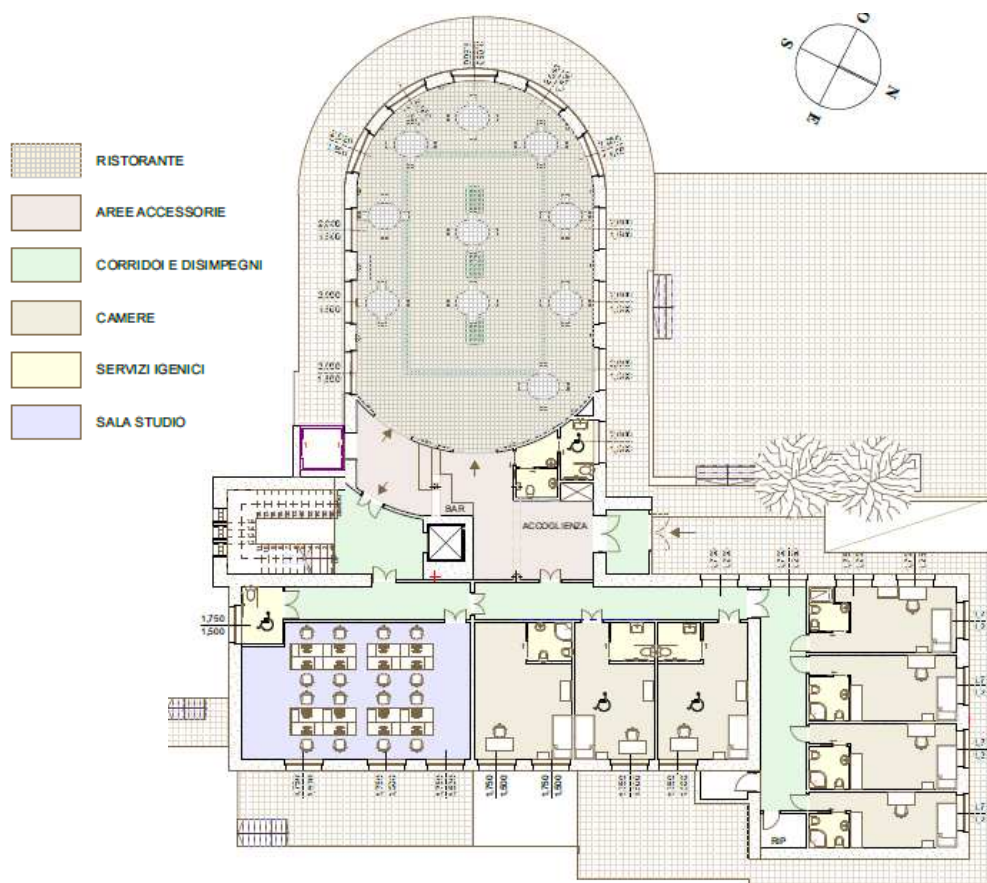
Pianta piano terra convitto, riferimento tav. B1
